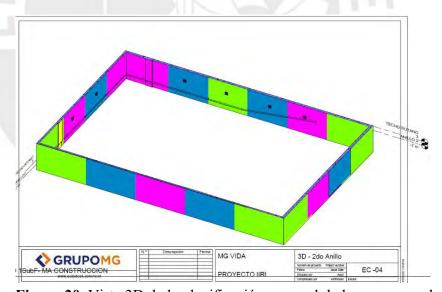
Vista 3D de la planificación semanal de los muros anclados del 2do anillo.
